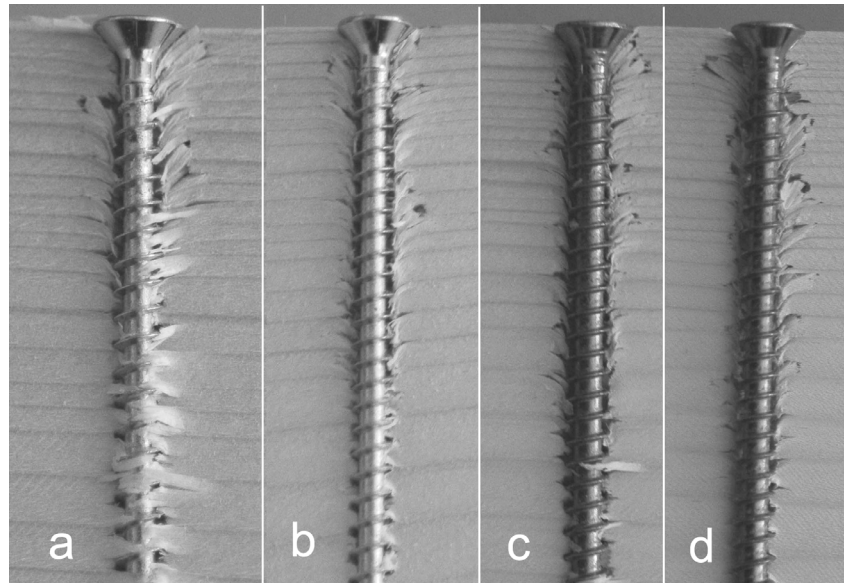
Eingedrehte Schrauben mit veränderlicher Gewindesteigung.
